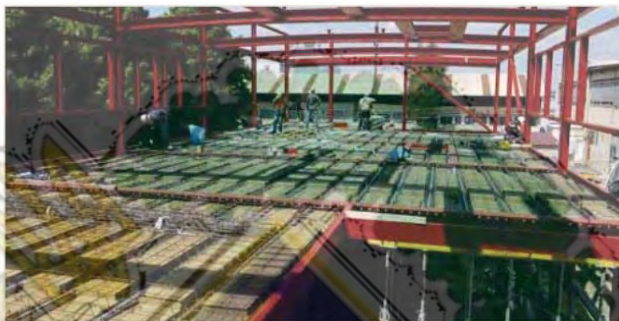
Плитний елемент безбалкового сталезалізобетонного перекриття
